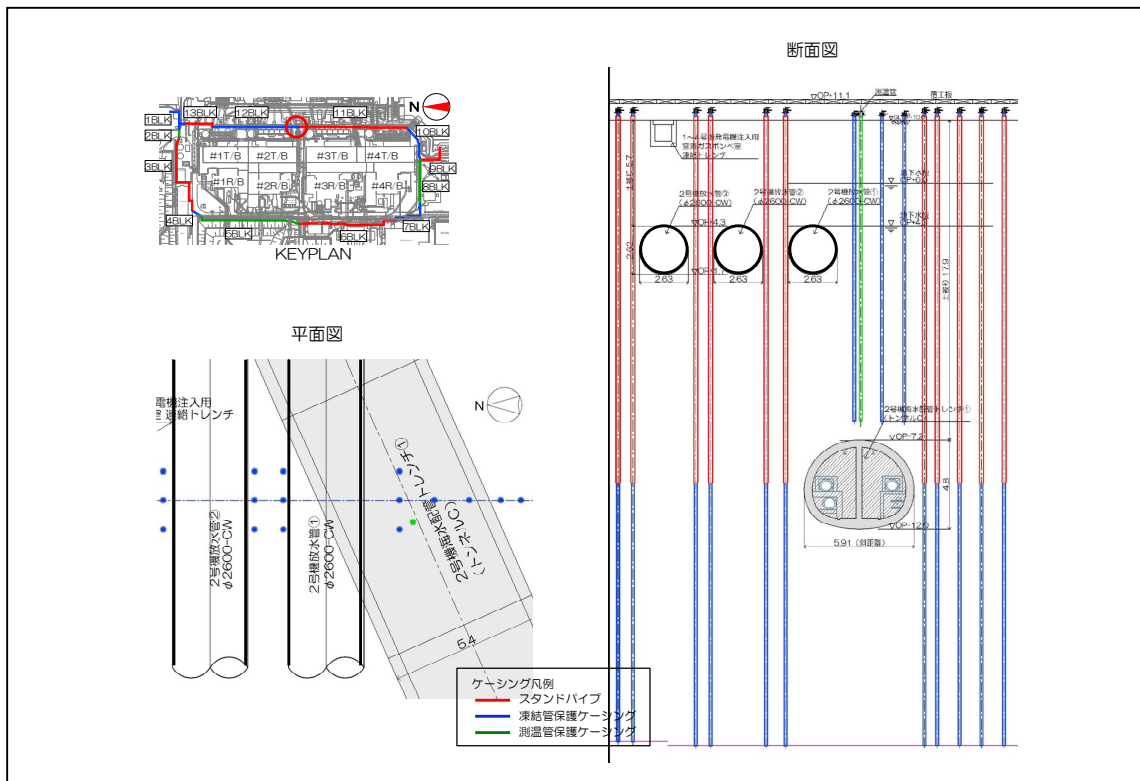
2号機海水配管トレンチトンネルC部 施工平面図・断面図
